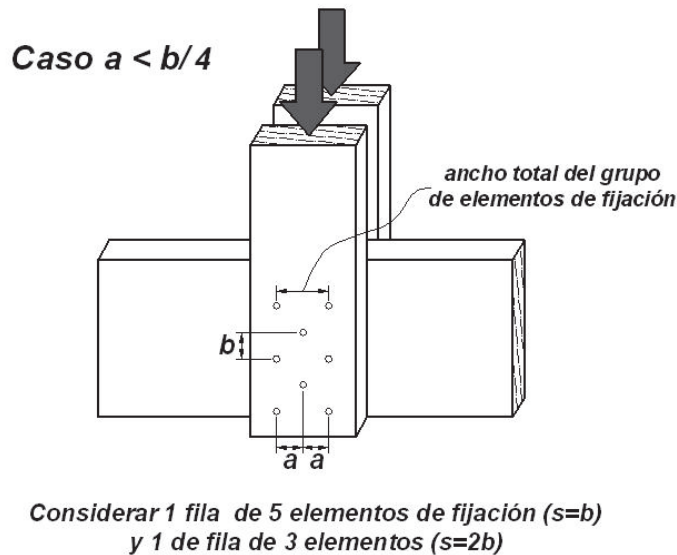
Acción de grupo en miembros cargados perpendicularmente a la dirección de las fibras y unidos con elementos de fijación colocados en tresbolillo.
